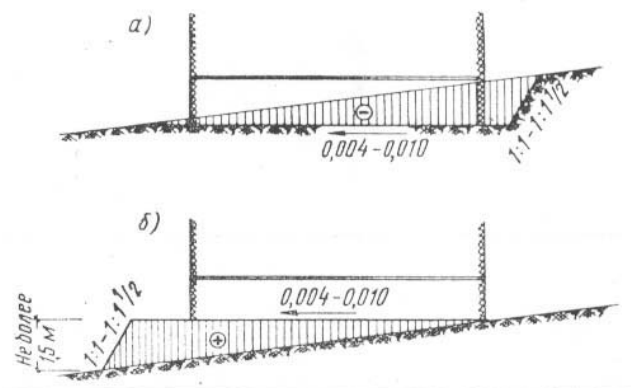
Площадки под здания: а – в выемке; б – в насыпи.
